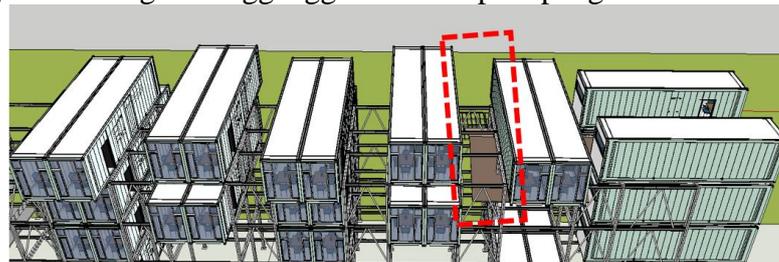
Pengkaku Baja dan Sambungan antara batang balok baja dengan modul peti kemas
